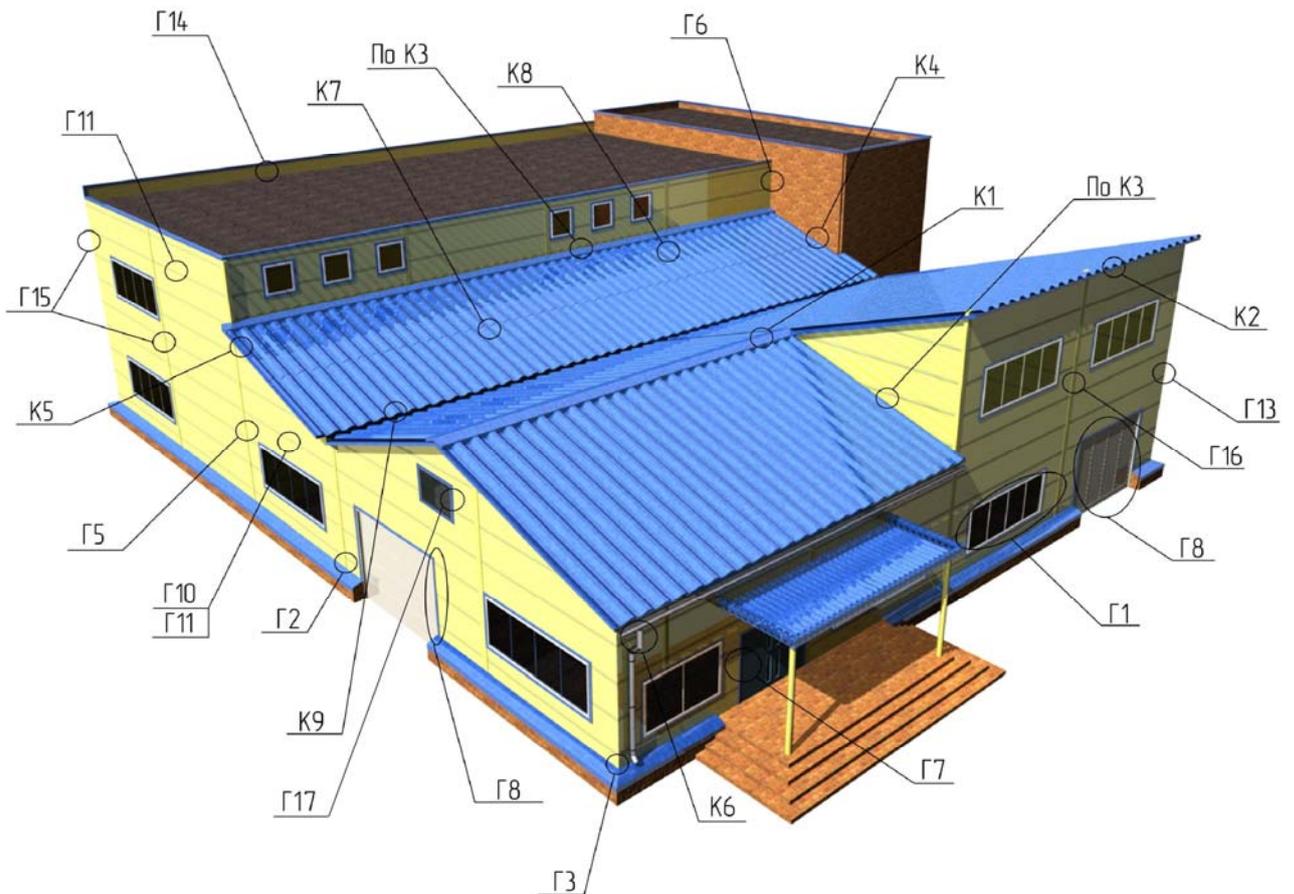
б – Здание с горизонтальной раскладкой стеновых панелей.
